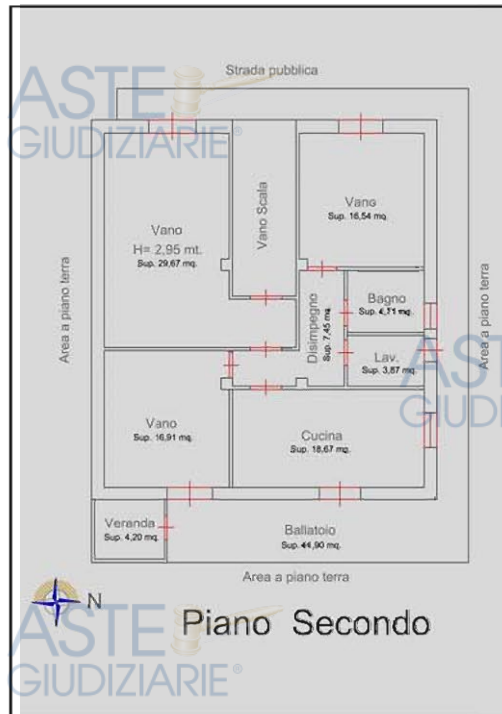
Visualizzazione della planimetria dell'immobile nello stato di fatto con indicazione delle superfici utili
